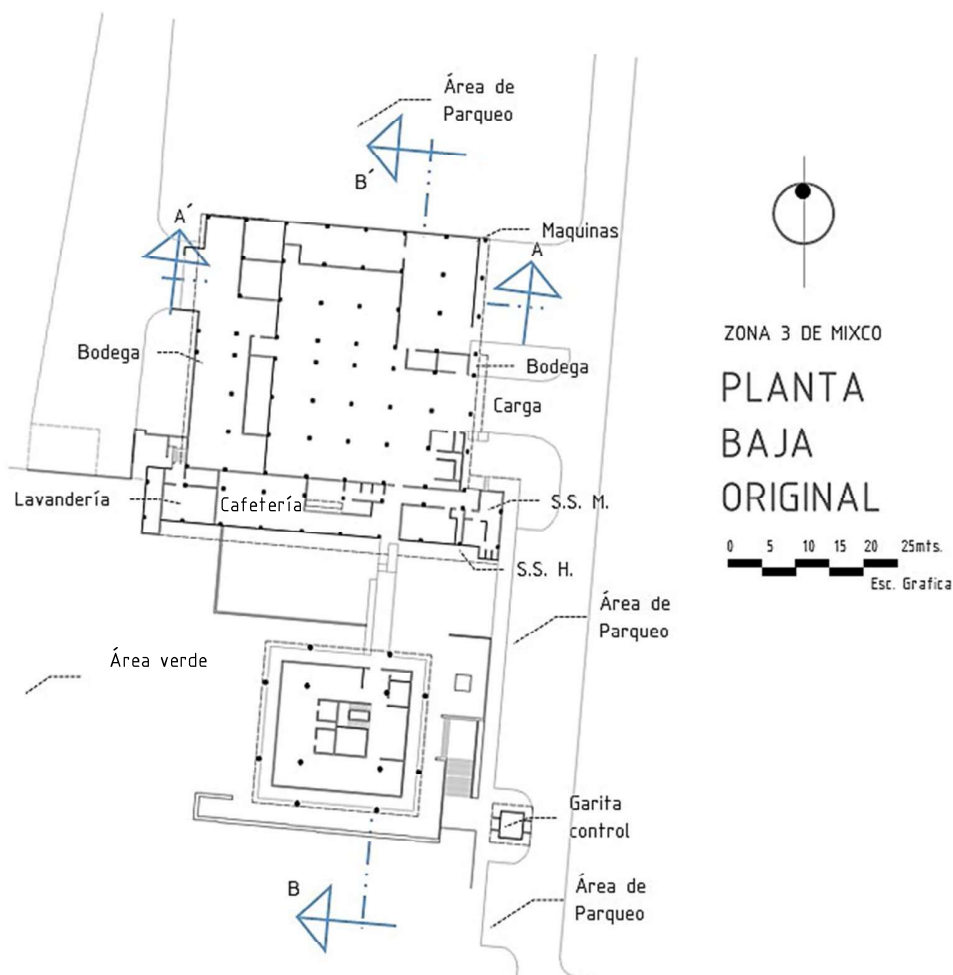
Planta baja, concepción original de Laboratorios Abbott.
